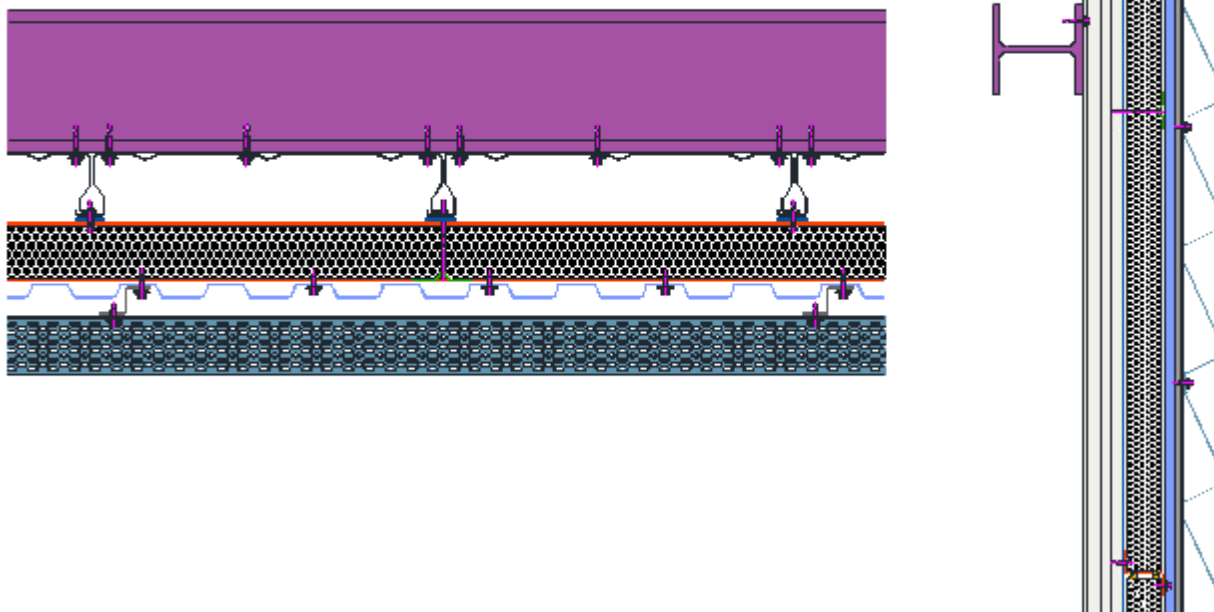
Coupe horizontale et verticale (exemple : plateaux verticaux 1^{er} écarteur horizontal, peau d'étanchéité verticale, 2^{ème} écarteur vertical et peau extérieure horizontale).
